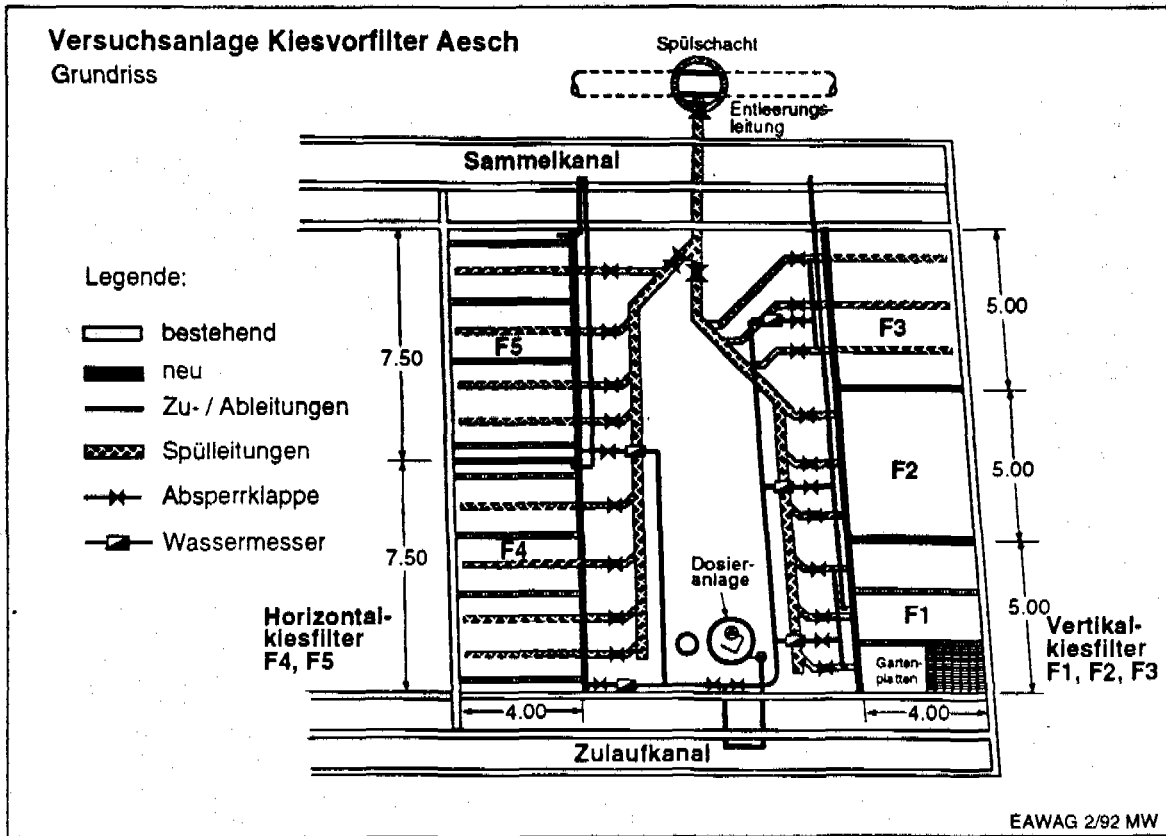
Grundriss der Kiesvorfilter in der Versuchsanlage Aesch
